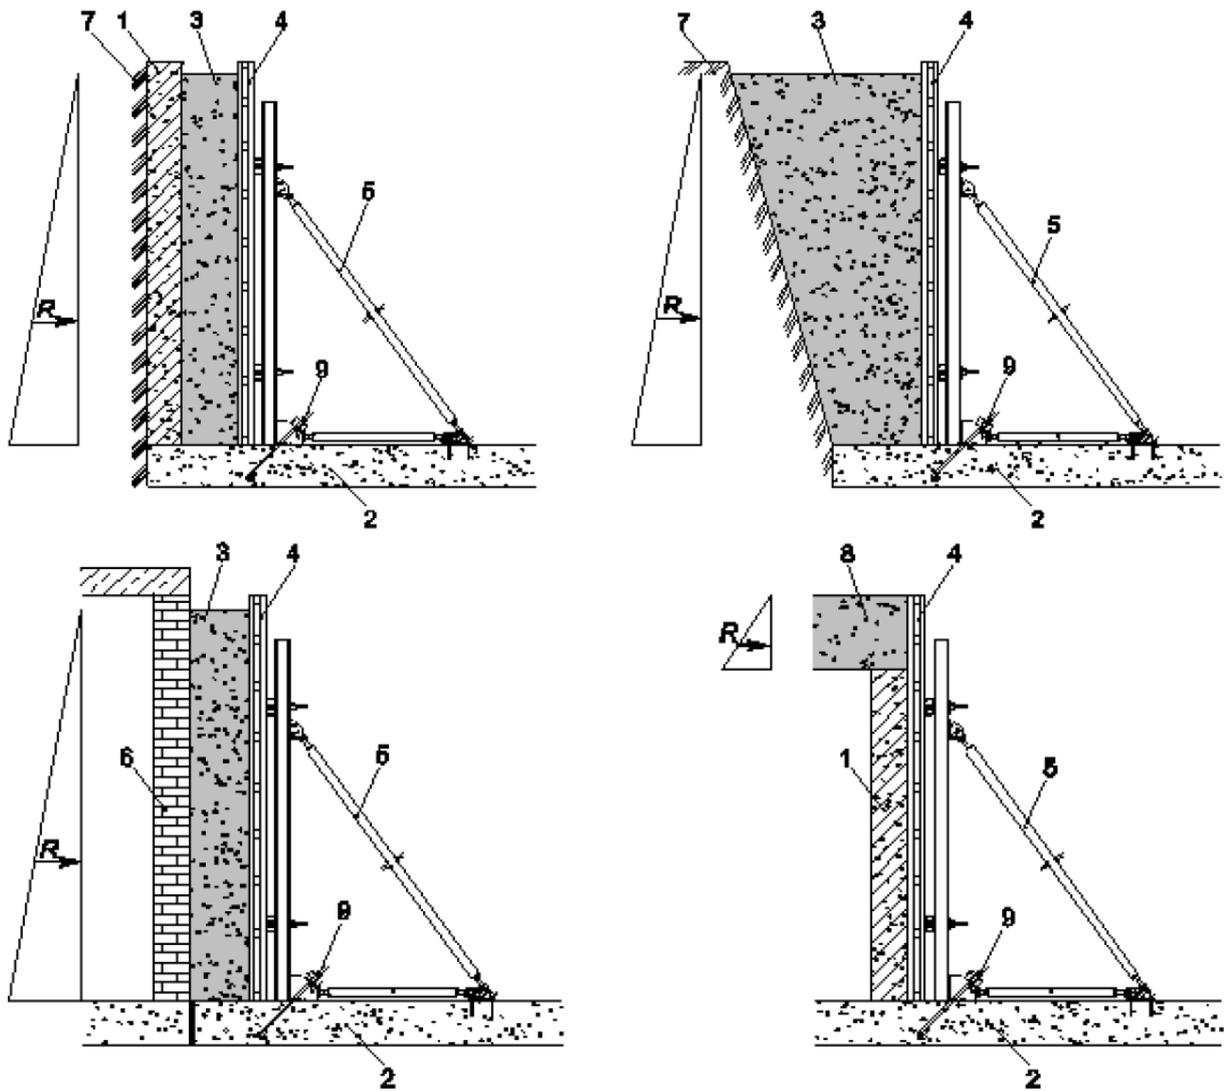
Схемы установки односторонней опалубки вертикальных монолитных конструкций и эпюры бокового давления. 1 — бетонная стена (шпунт); 2 — бетонная плита; 3 — возводимая монолитная конструкция; 4 — стенная опалубка; 5 — подкосы; 6 — кирпичная стена; 7 — стена котлована; 8 — плита перекрытия; 9 — анкер
